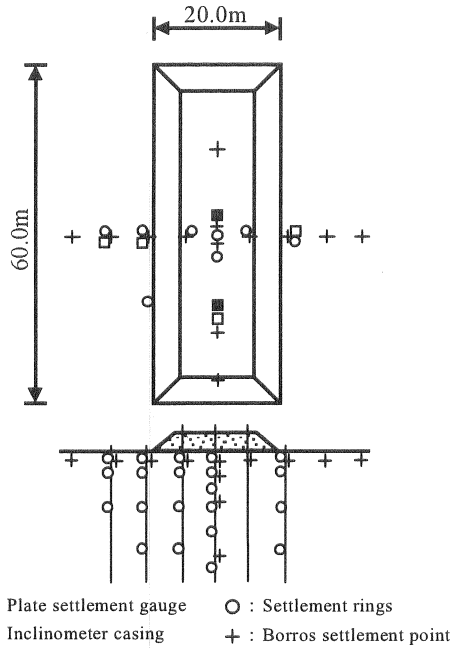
試験盛土の平面図・断面図および観測計器の配置状況<sup>7)</sup>
